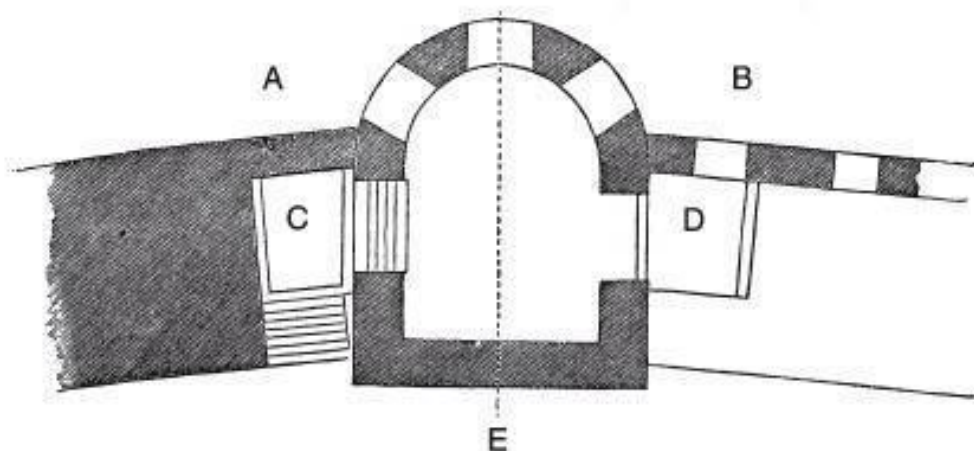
План одной из башен Каркасона: А — план первого этажа; В — план второго этажа; С и D — выемки, расположенные под подъемными мостами
